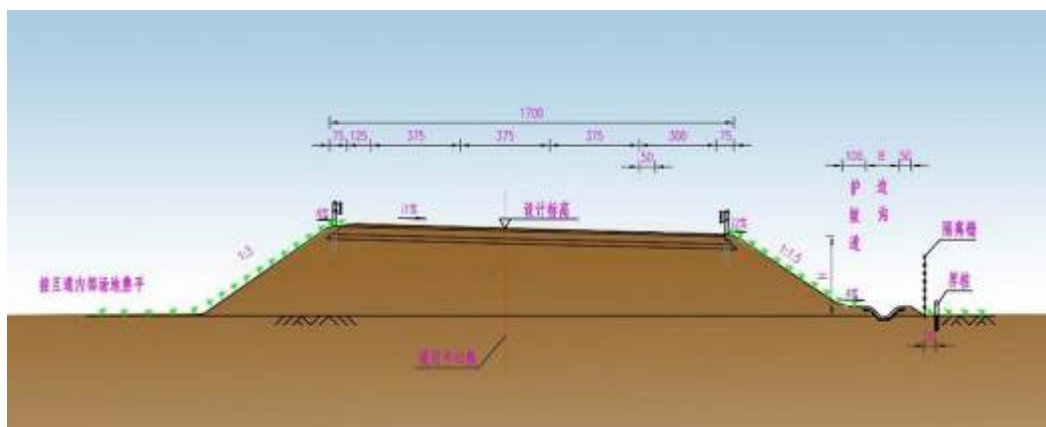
(6) 单向三车道匝道路基标准横断面图
